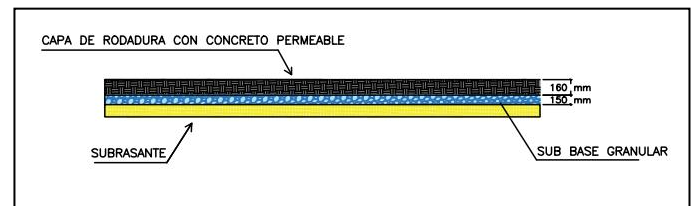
Propuesta de pavimento permeable final según diseño AASHTO 93
